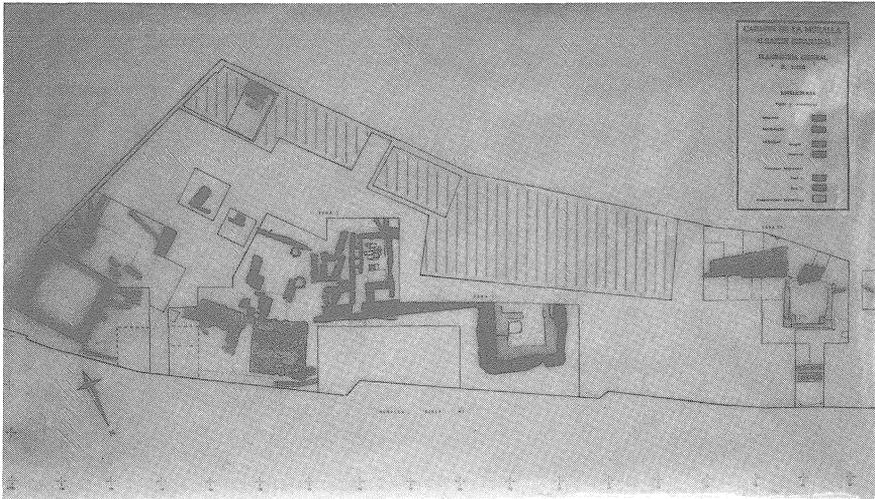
Planimetría general del Carmen de la Muralla (Albaicín, Granada) tras la Campaña de 1991.
